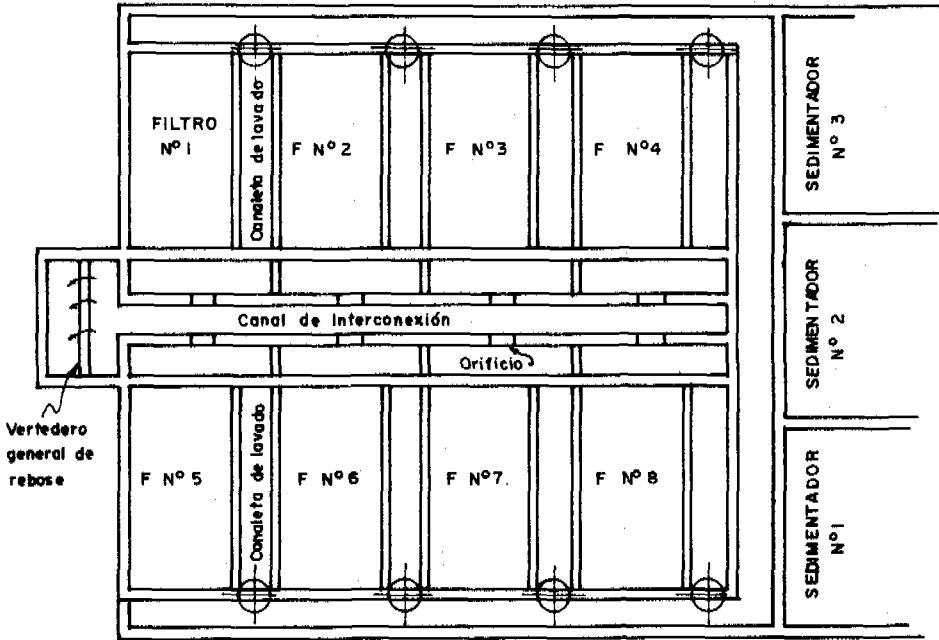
FILTRO CON ORIFICIO DE CONTROL - PLANTA
